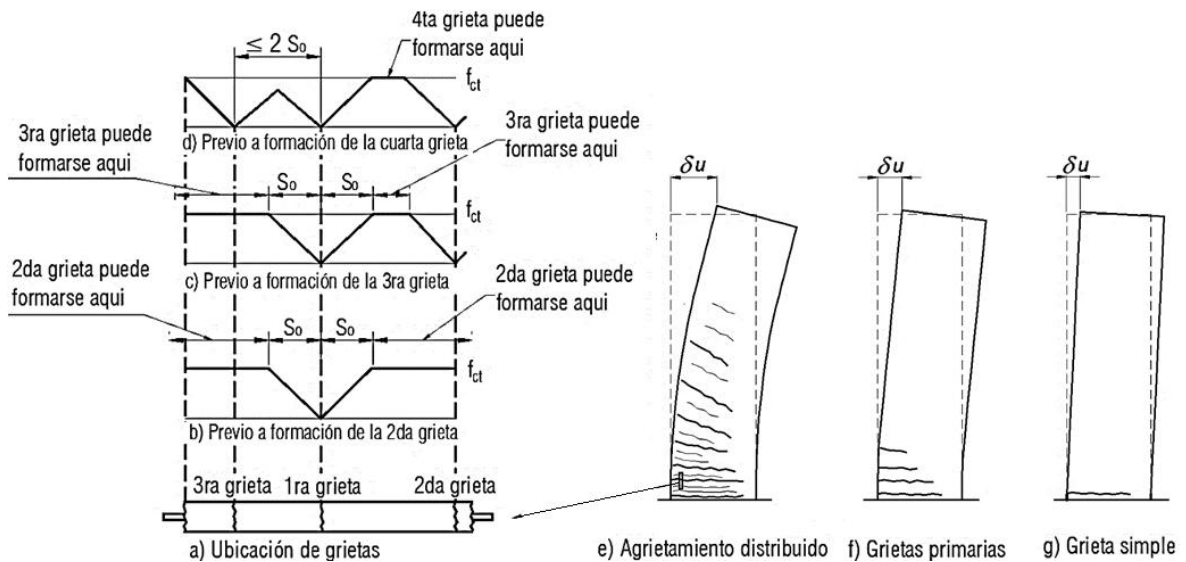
Patrón de grietas típicas en muros [49].
